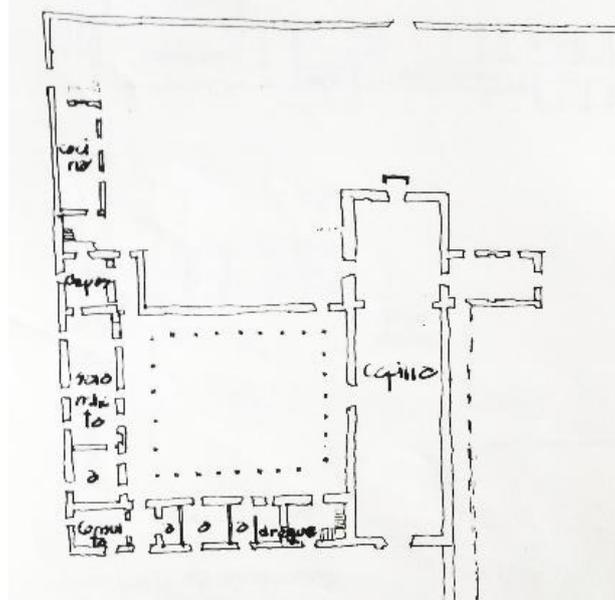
Plano del Claustro de la Iglesia de San de 1614. Fuente: Plano elaborado por la Arquitecta María Isabel Mayorga, 1995
